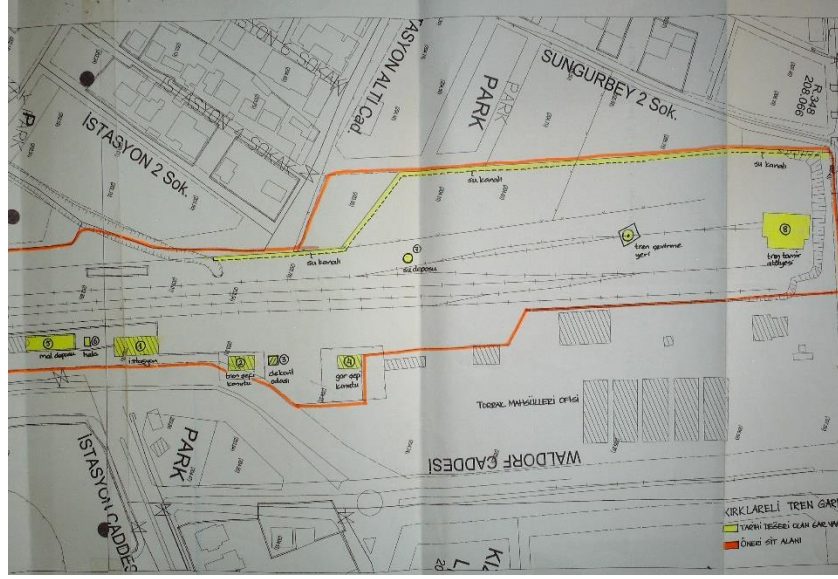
Kırklareli Gar Binası Vaziyet Planı
